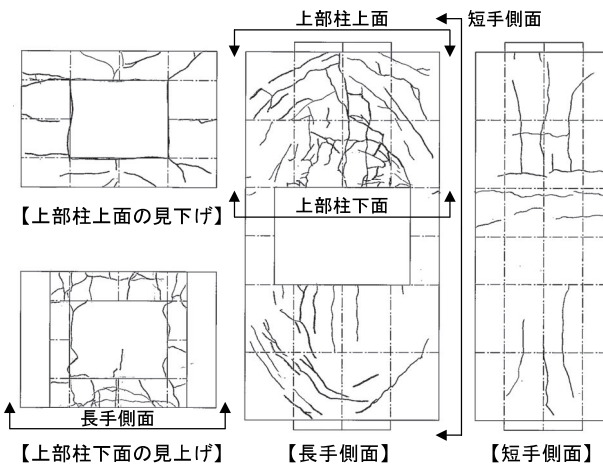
実験終了時のひび割れ状況 (No.5)
